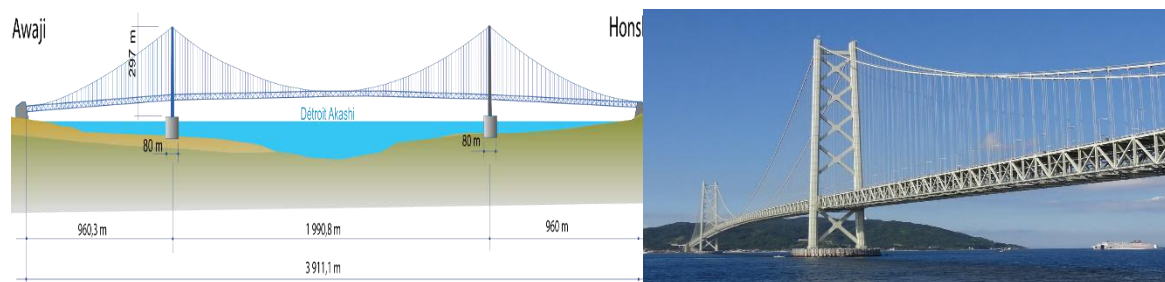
,1.2- Podul Akashi Kaikyo Bridge[141]
